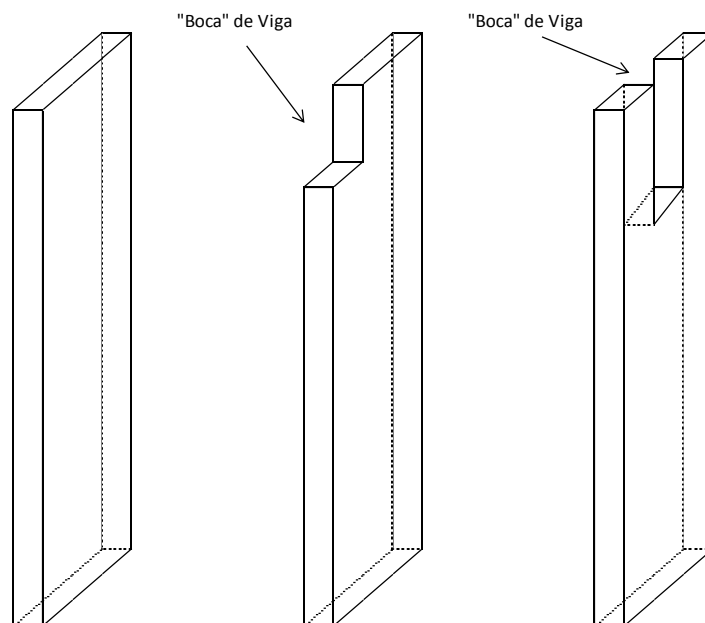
Exemplos de painéis de formas para pilares. Fonte: Própria.
